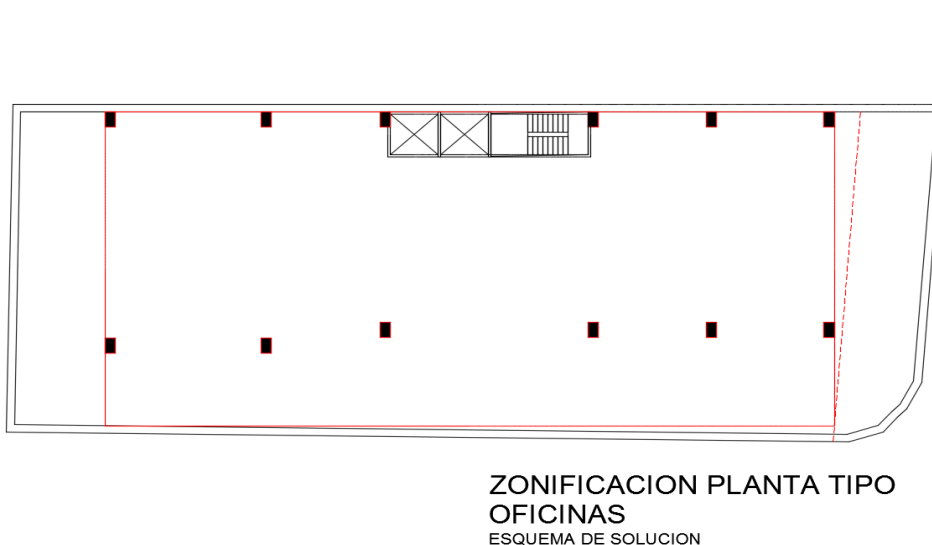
PLANTA ESQUEMATICA OFICINAS
